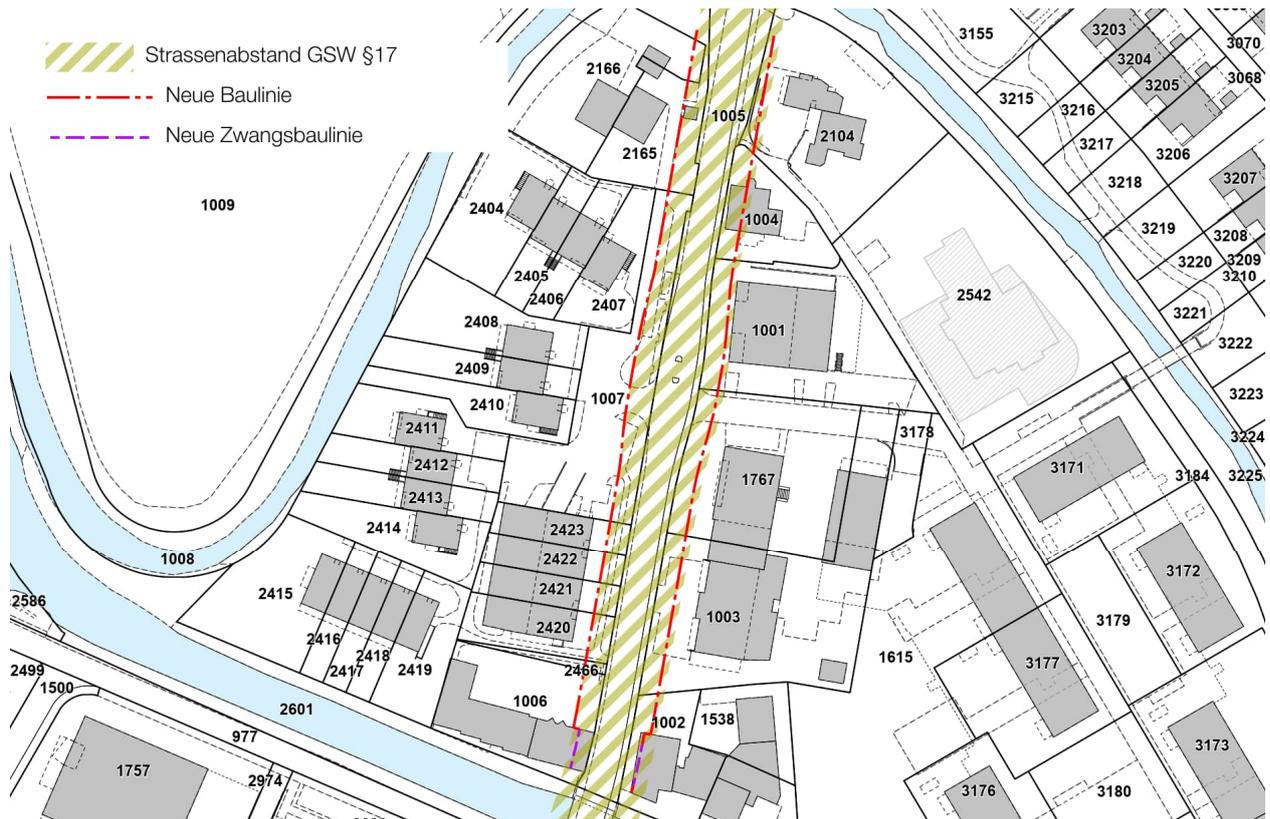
Darstellung Bezug der neuen Baulinien zum Strassenabstand nach §17 GSW (ohne Massstab, genordet)
